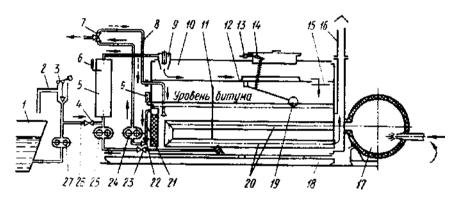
Битумонагревательный агрегат (нагреватель битума) непрерывного действия:
